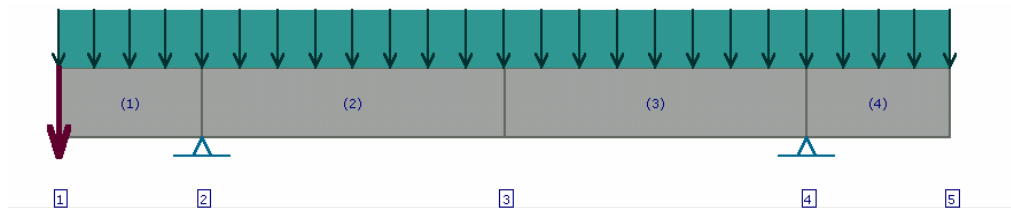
Distribución Cargas perfil secundario con dos apoyos Perfimet R.30 D
